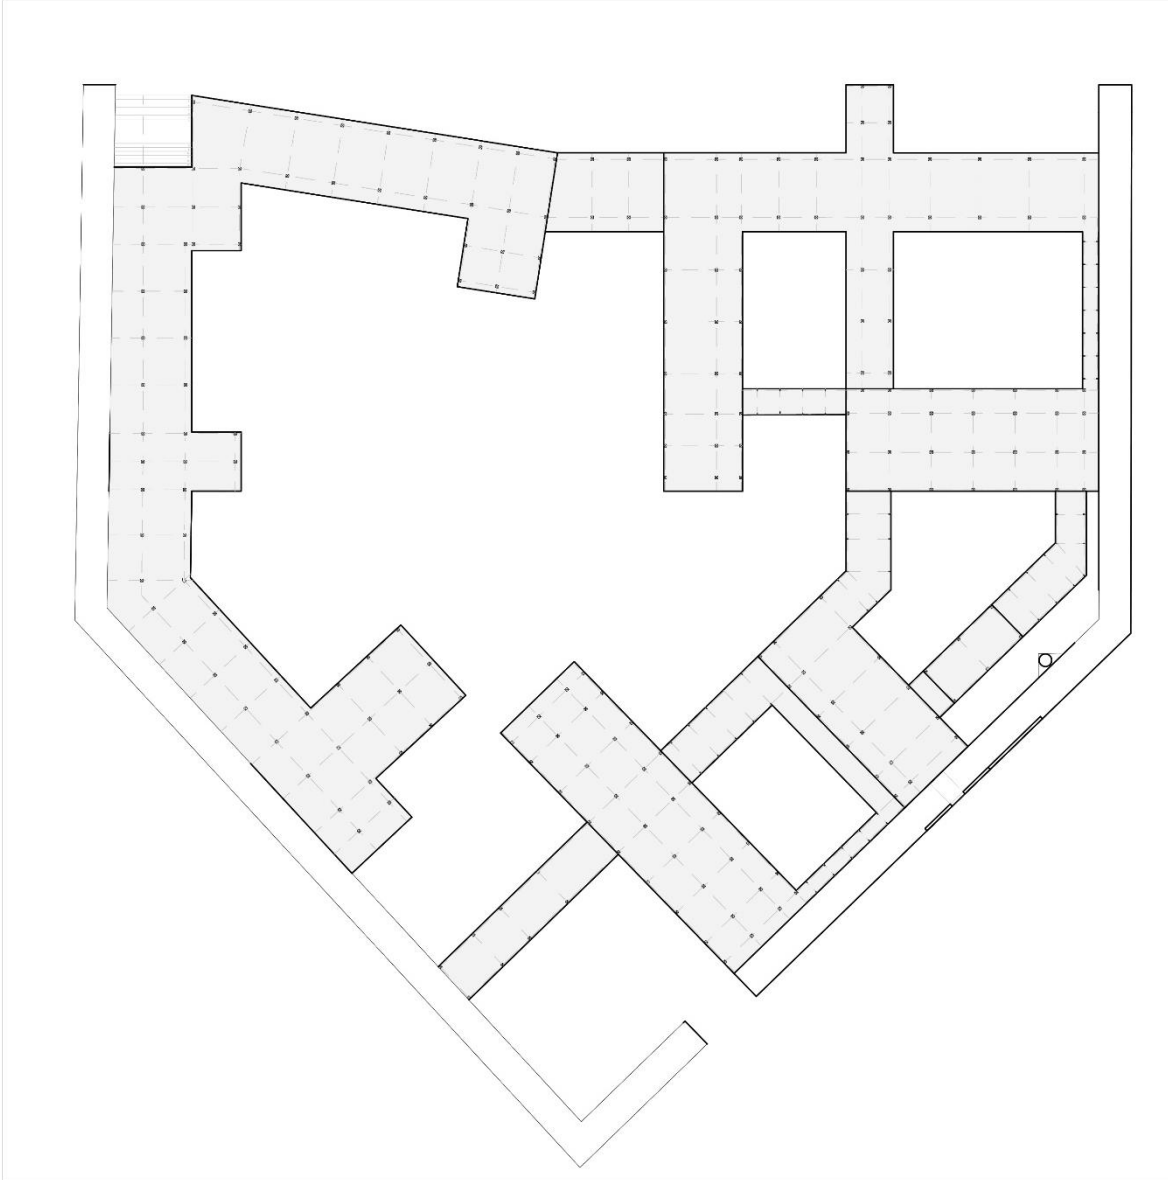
Planta da estrutura, com a identificação da malha estrutural e dos pilares . Elaborado pela autora
